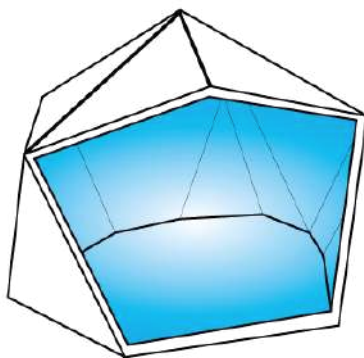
A5- Quinta alternativa telhado - eliminação forma superior da estrutura
